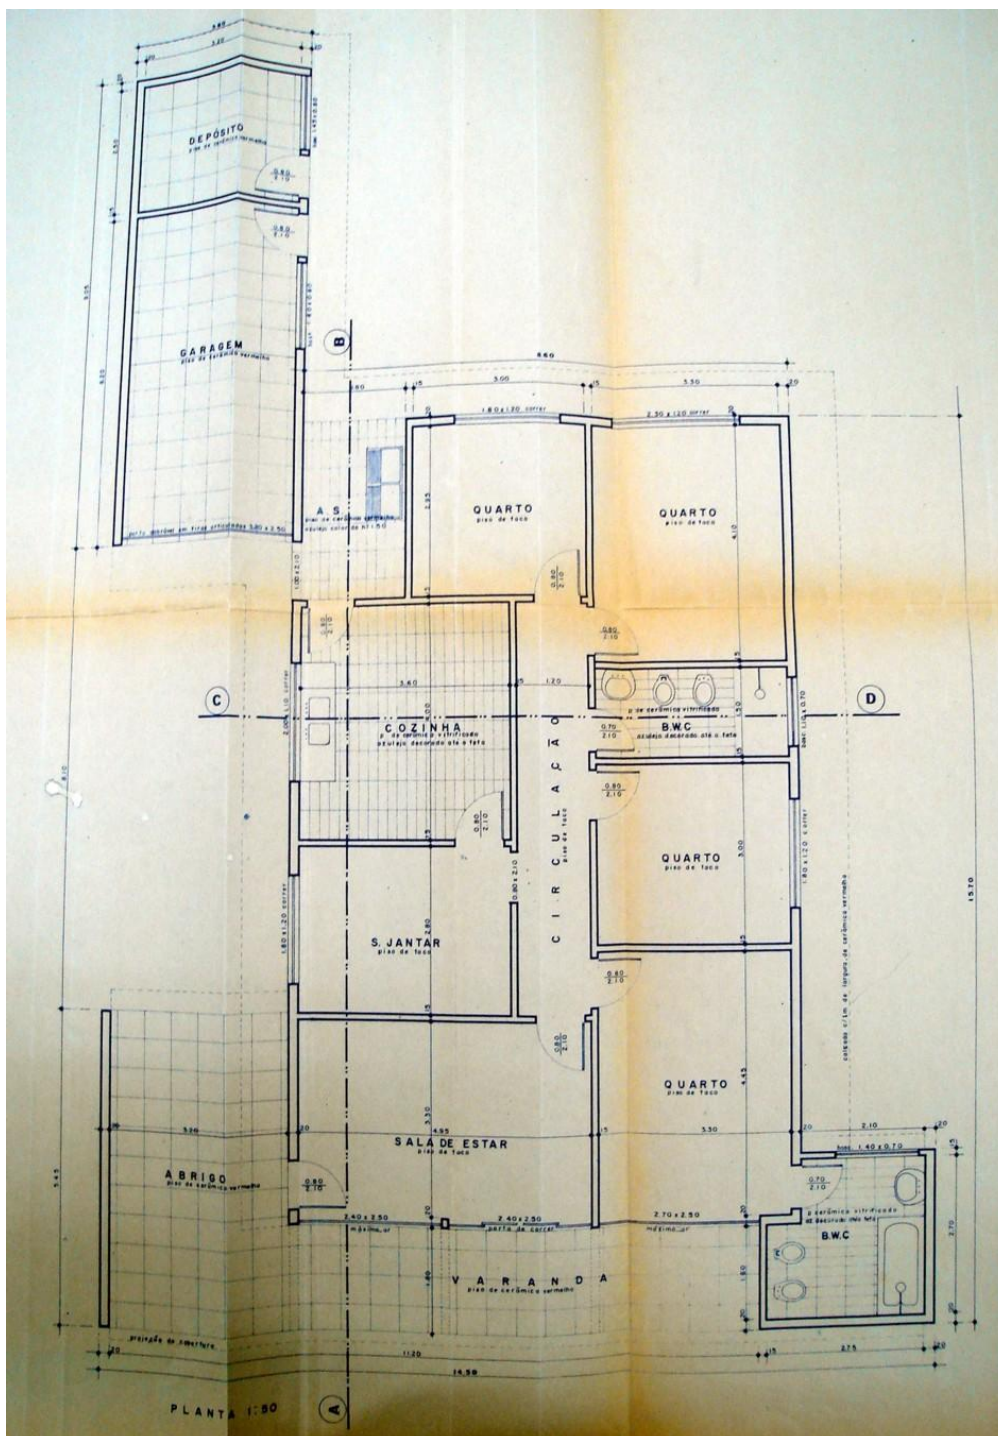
Projeto Arquitetônico / Planta baixa (Residência da Rua Neo Alves Martins, nº 969)
